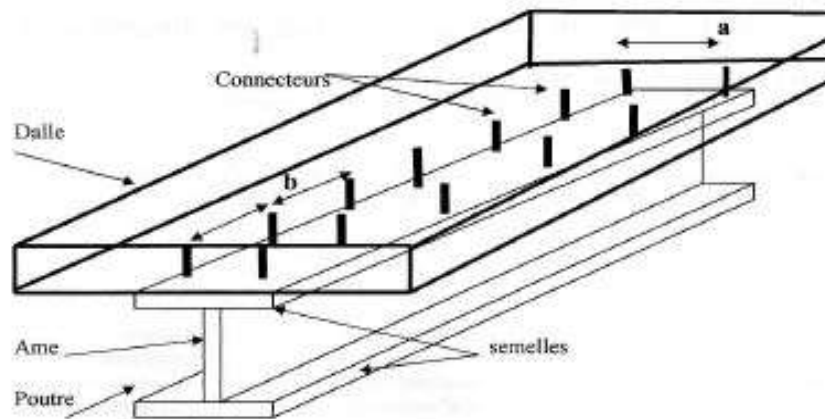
Espacement et disposition des connecteurs sur la semelle supérieure
